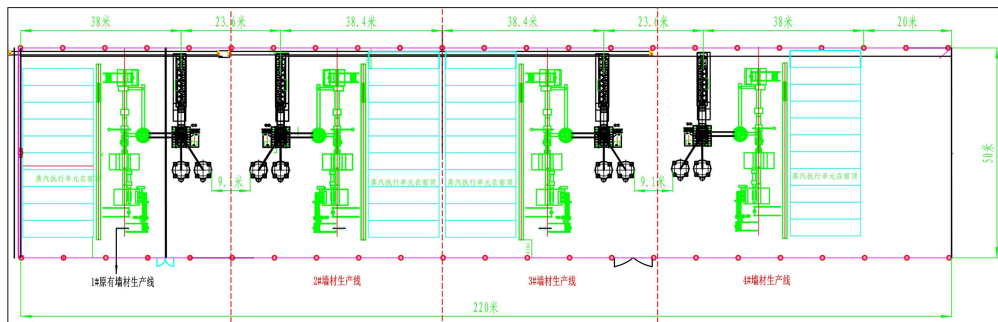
环评阶段利旧厂房（墙材生产线）总平面布置示意图
